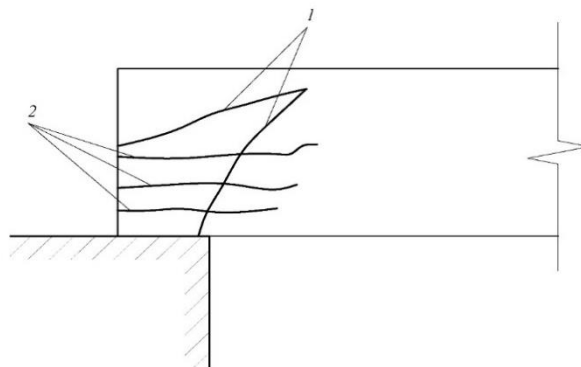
Трещины в опорной части железобетонного элемента: 1 – при нарушении анкеровки арматуры; 2 – при недостаточности косвенного армирования сечения.
